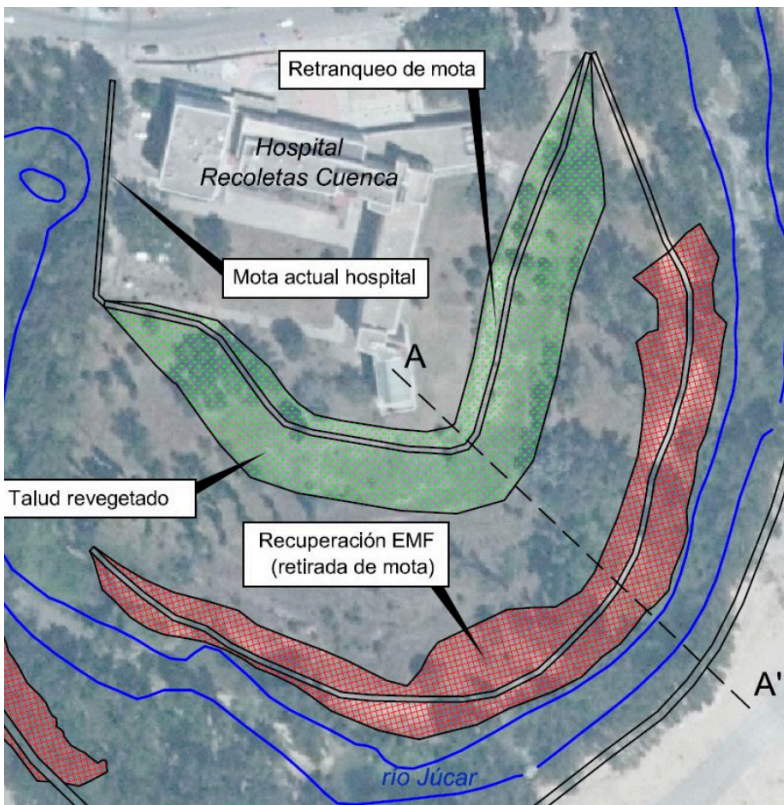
Vista en planta de la intervención en el hospital de Cuenca.
